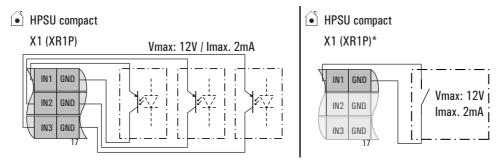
Collegamento ingresso impulsi del contatore di corrente (* collegamento alternativo)
